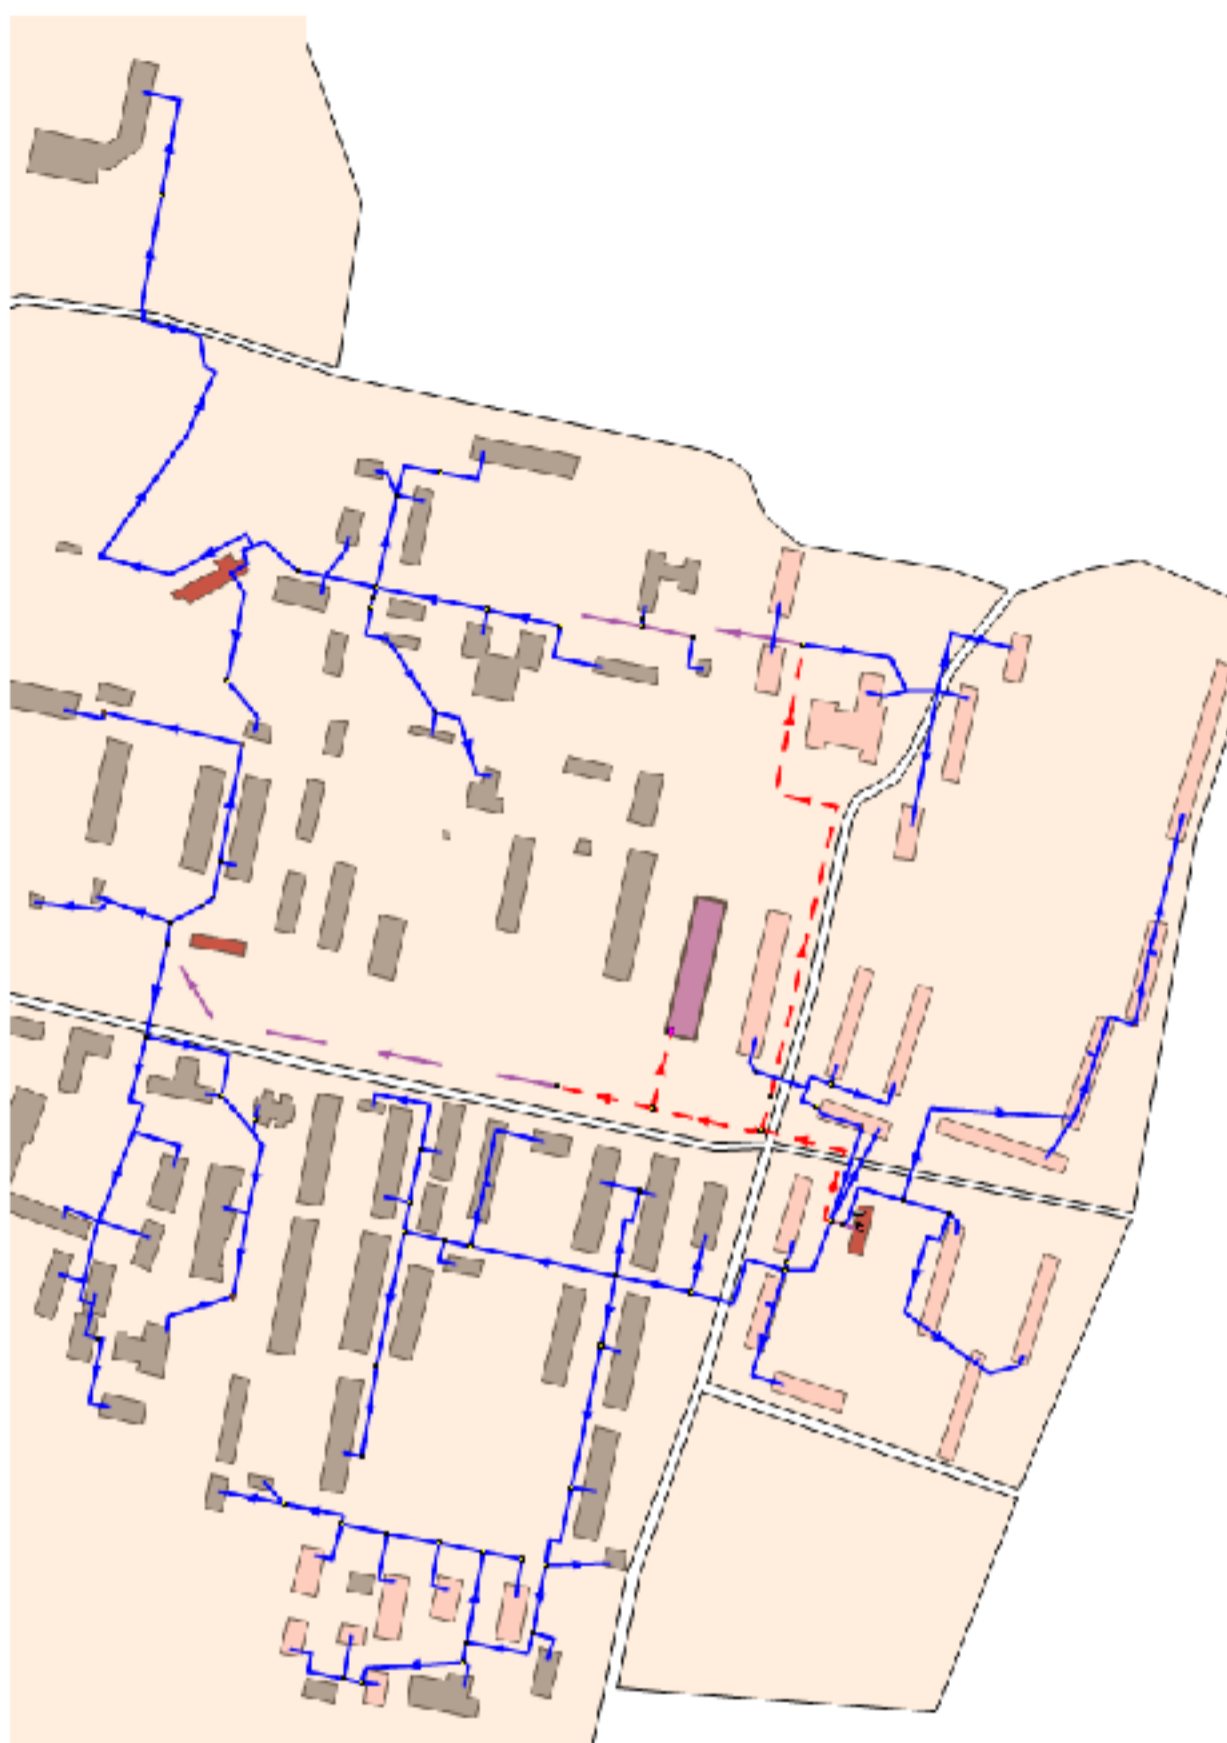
Схема объединенной тепловой сети системы отопления после осуществления второго этапа реконструкции (общий вид)
